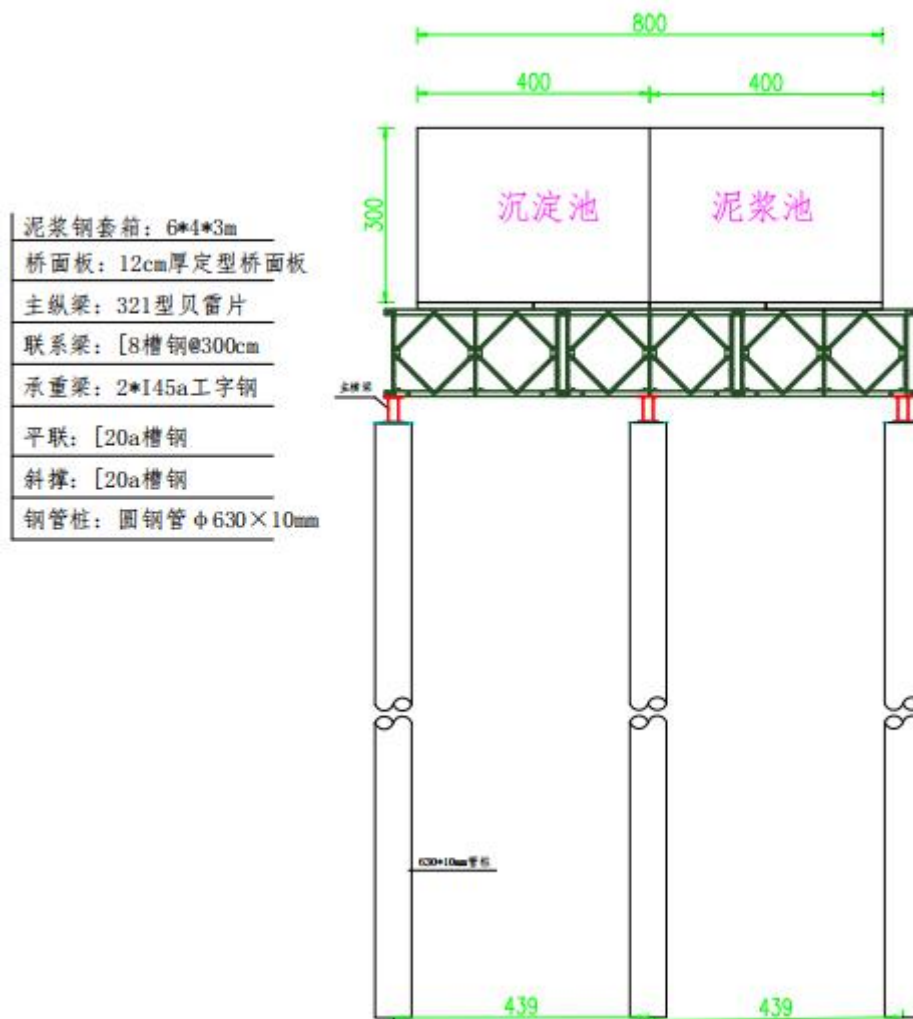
水上定型钢化钢结构泥浆池及沉淀池平台纵断面图
